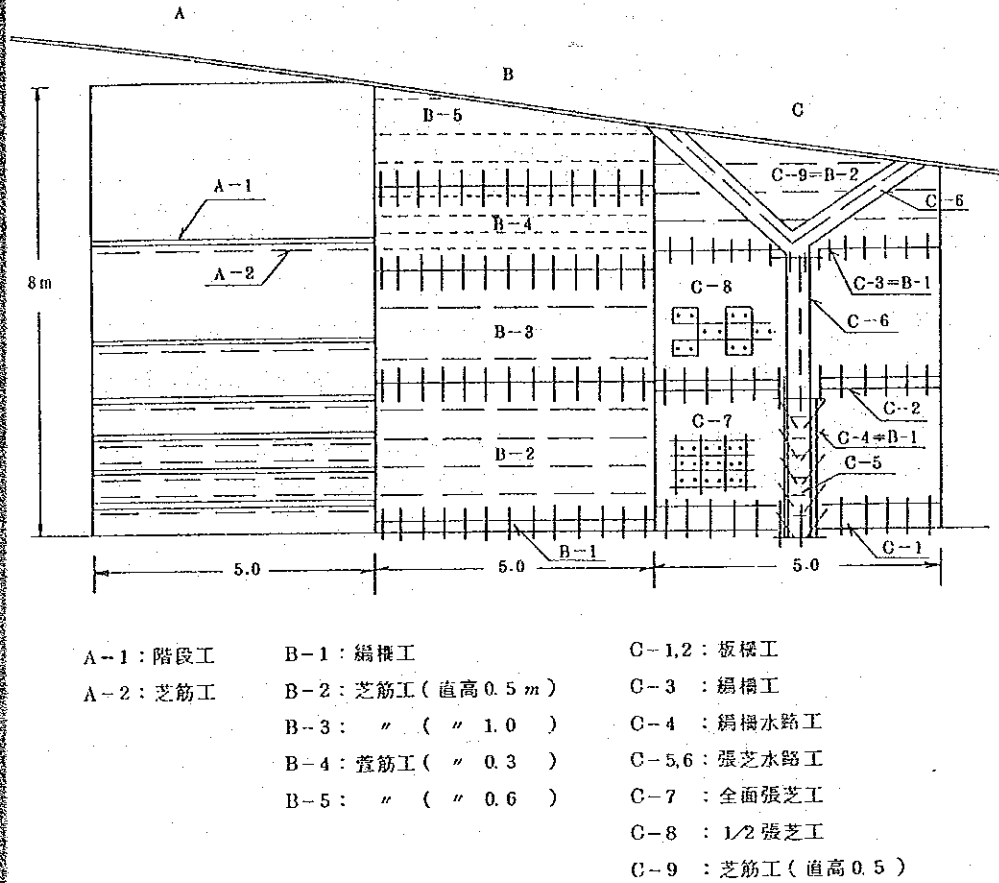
簡易治山工作物施工平面図 (1983年) 1/100
